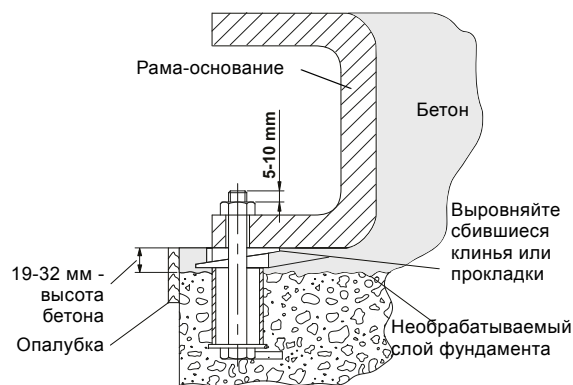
Вид в разрезе фундамента с фундаментным болтом, бетонной заливкой и рамой-основанием
